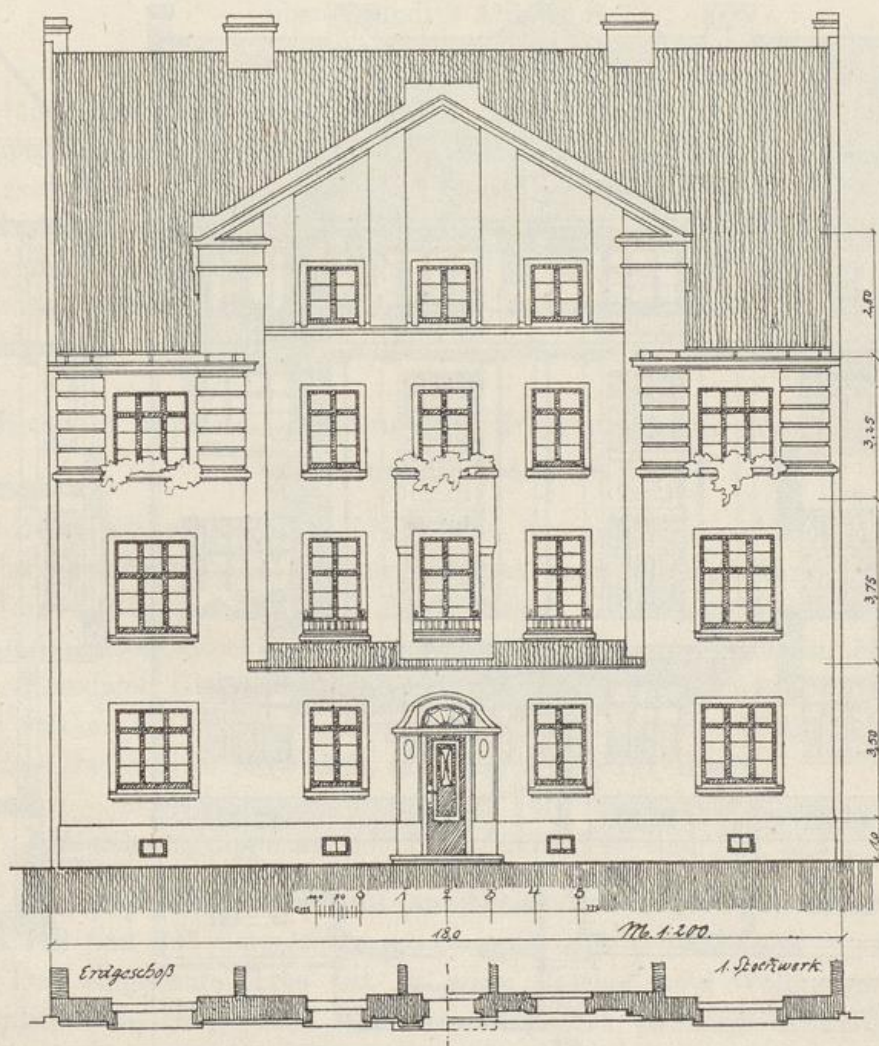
Mietshaus mit zwei gleichen Wohnungen in jedem Geschoß, dementsprechend symmetrische Fassade über Grundriß Abb. 93 S. 72.
